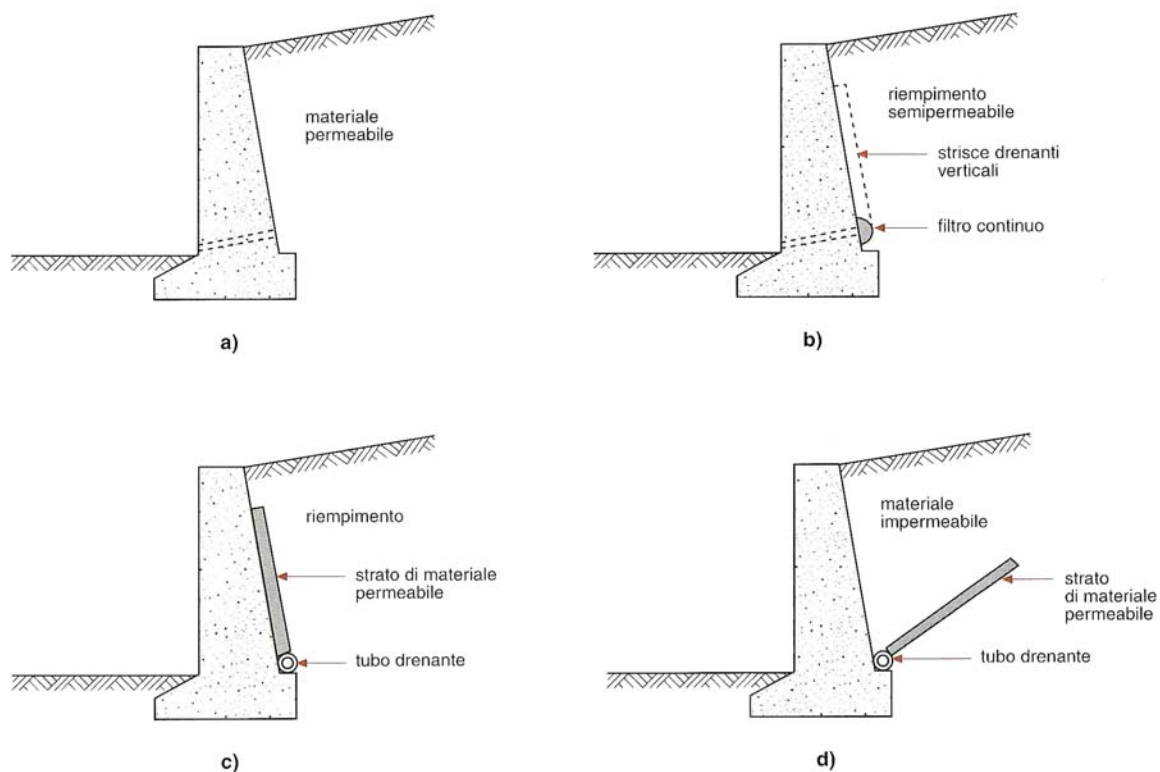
Alcuni esempi di sistemi di drenaggio che possono essere utilizzati per lo smaltimento delle acque alle spalle di una struttura di sostegno: a) utilizzo di materiale drenante come riempimento alle spalle del muro; b) sistema di drenaggio utilizzabile nel caso di materiale di riempimento semipermeabile; c) e d) sistema di drenaggio utilizzabile nel caso di riempimento in materiale impermeabile (da COLOMBO et al., 1996) -
